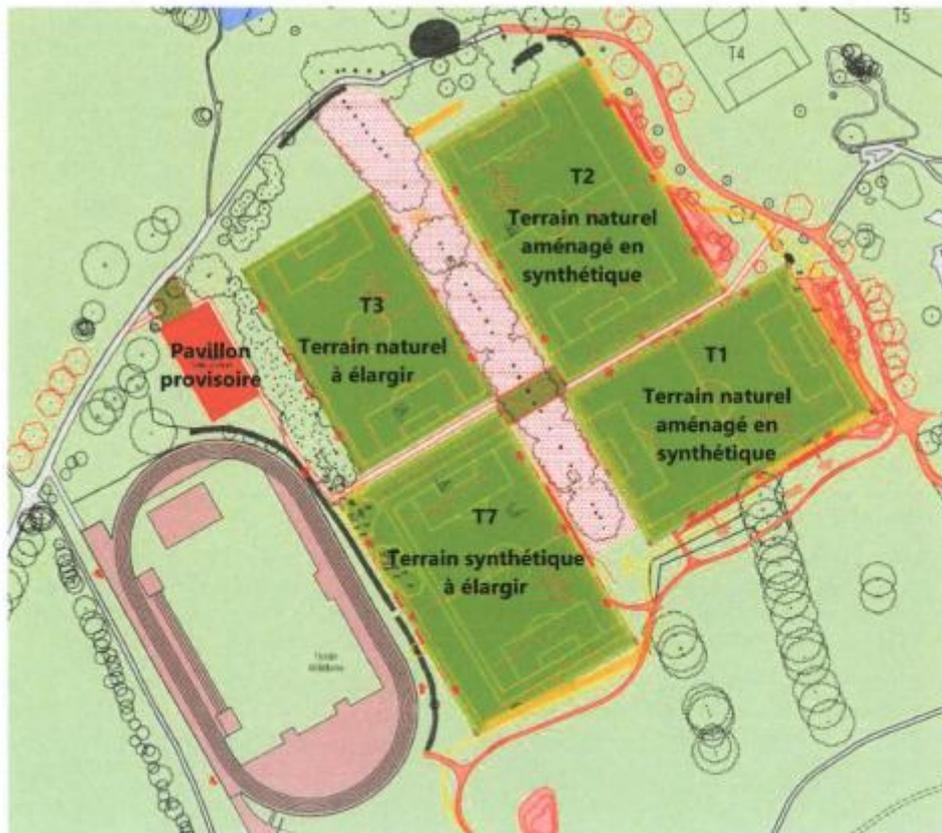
Extrait du plan de situation (source : Plan A04 du dossier de DD, BATEC, avril 2021)
